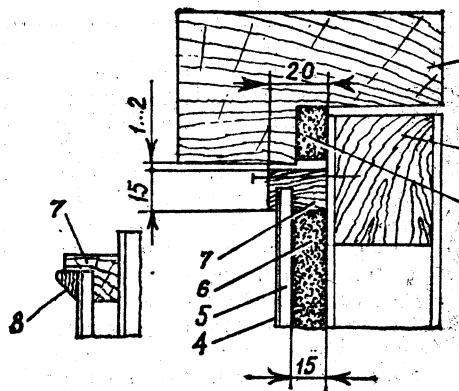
Обивка двери оргалитом: 1 — дверная коробка; 2 — входная дверь; 3 — уплотнитель, 4 — шпон; 5 — оргалит; 6 — утеплитель, 7 — рамка; 8 — штилик
